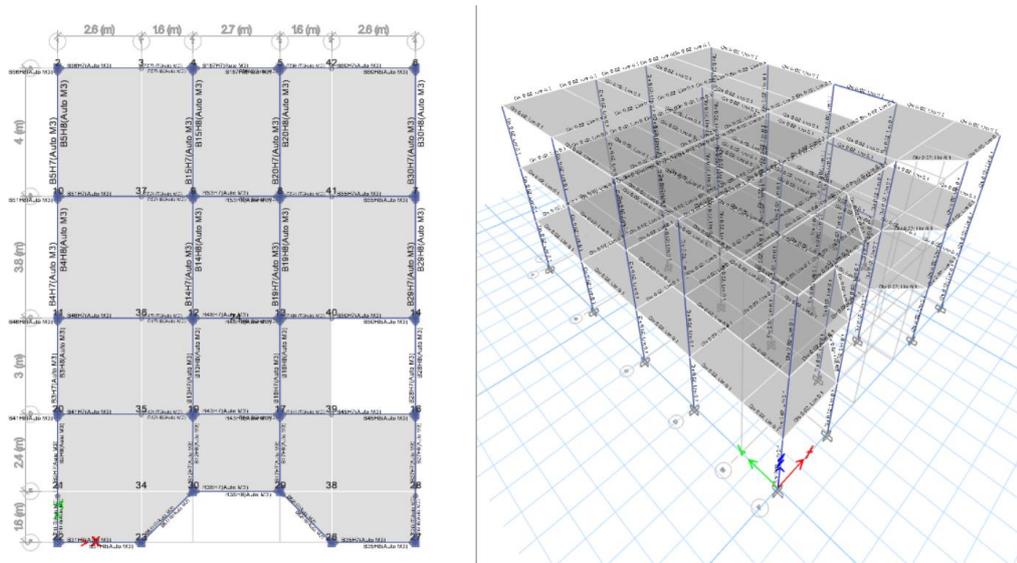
Rotulas Plásticas asignadas en vigas y columnas por medio del software, vista en planta y en 3D.
